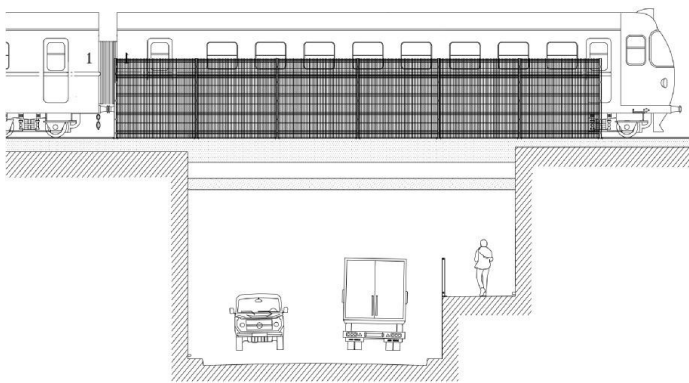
Estrutura Passagem Inferior Bombero Ossandon
